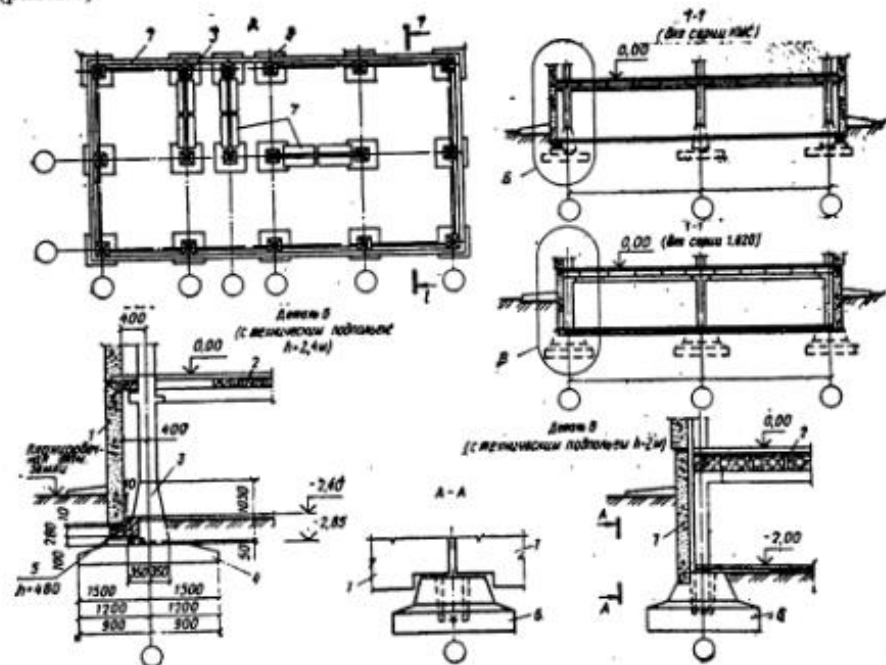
Фундаменты каркасно-панельного здания: А - схема плана; Б - схема разреза при фундаментных подушках; В - то же, при фундаментах стаканного типа; 1 - наружная цокольная панель; 2 - цокольное перекрытие; 3 - пирамидальное основание колонны; 4 - фундаментная подушка; 5 - фундаментная балка; 6 - фундаментный стакан; 7 - фундаментный блок
